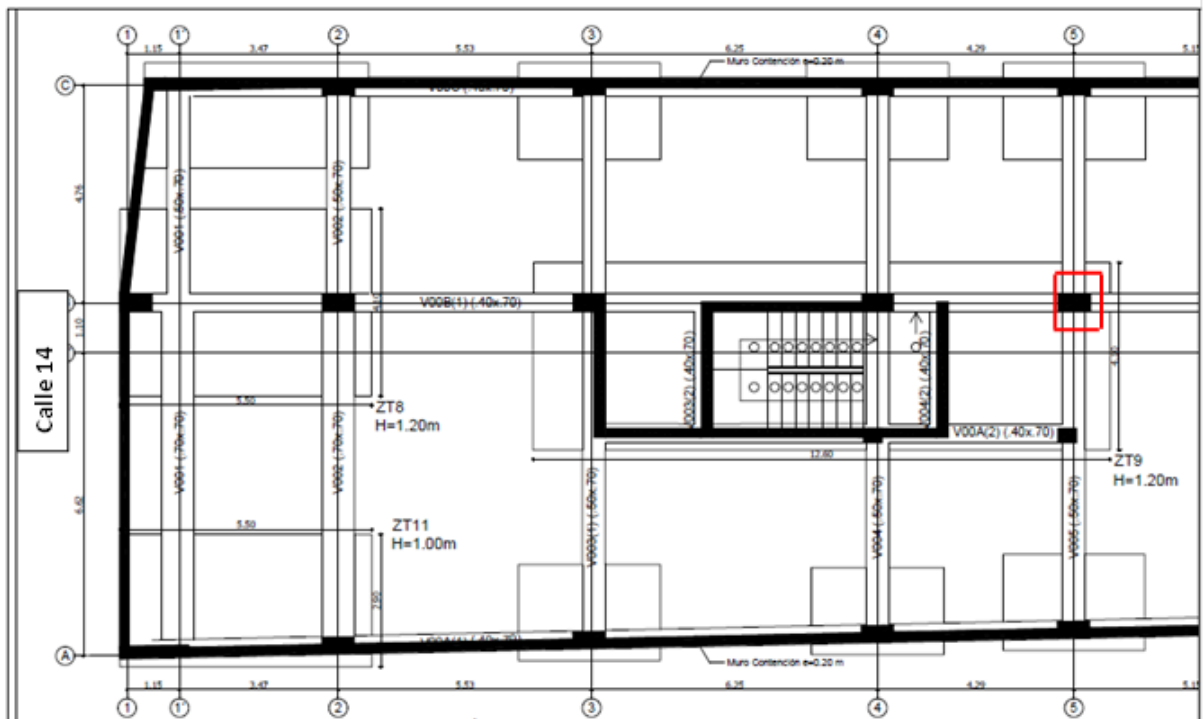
Ubicación de la columna B-5 en el Sótano.
